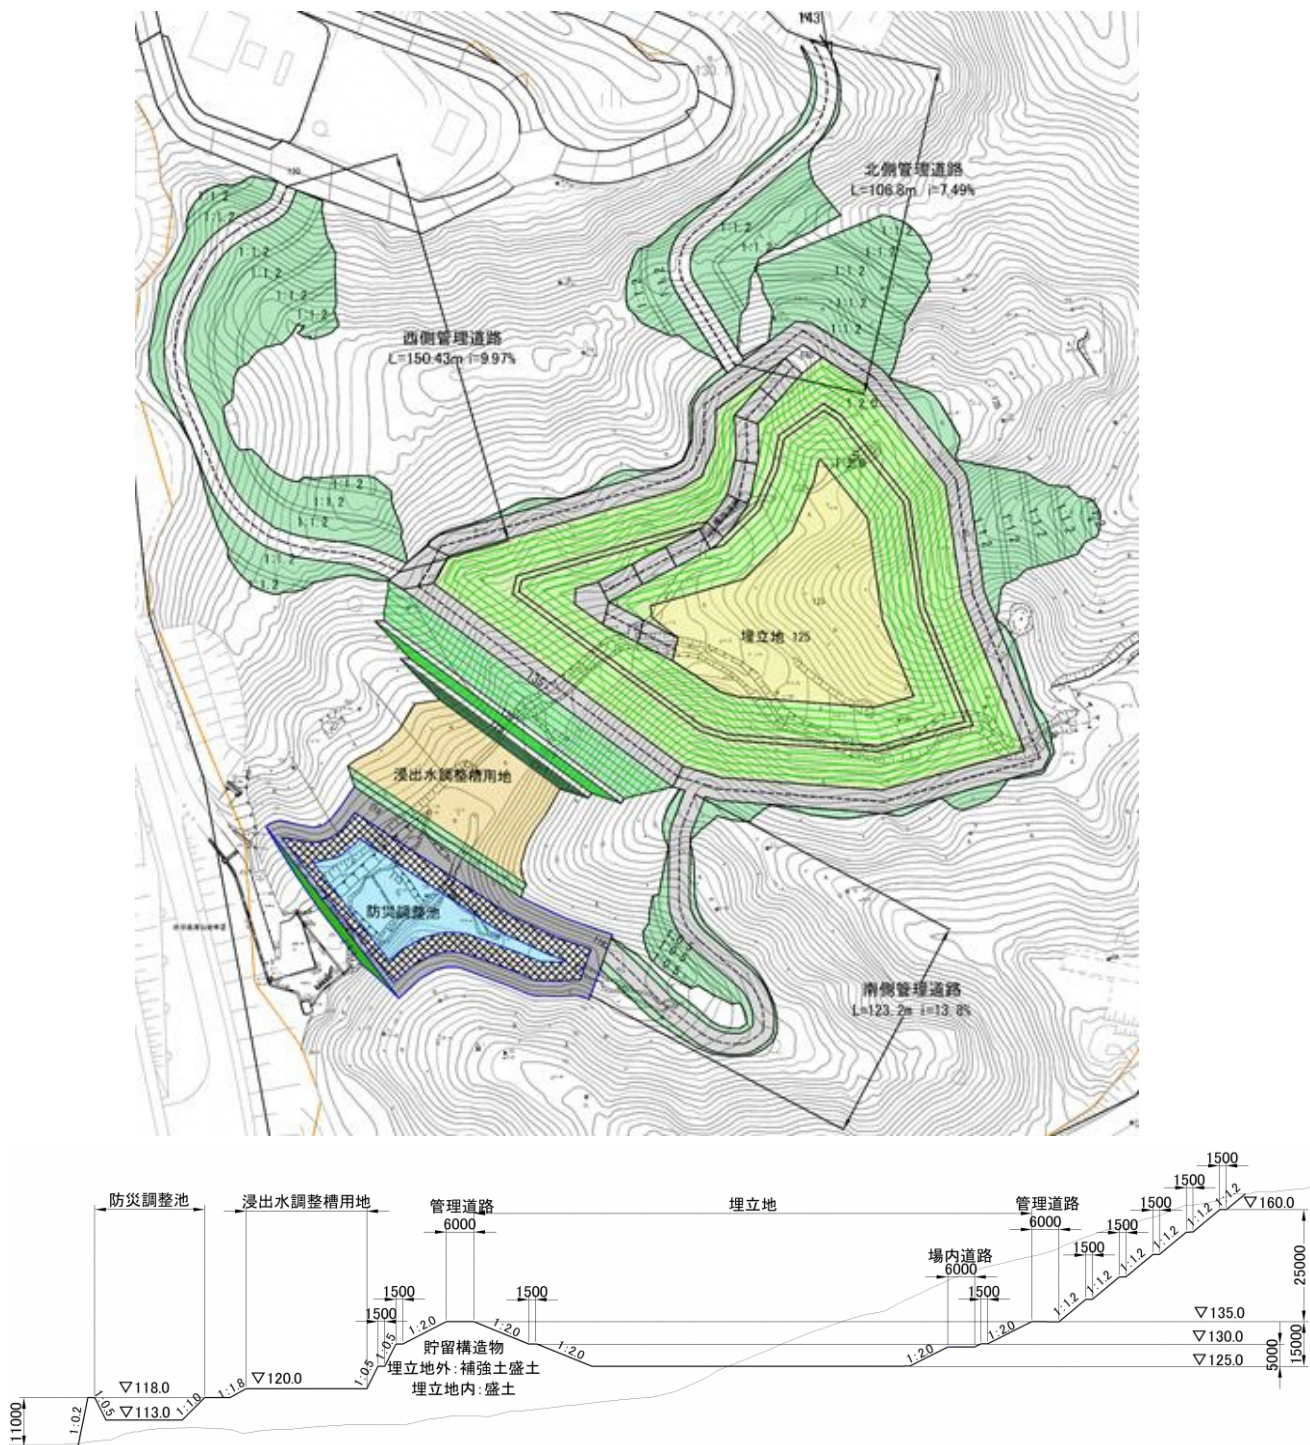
基本計画 (案2) 平面図 (上)、標準断面図 (下)
